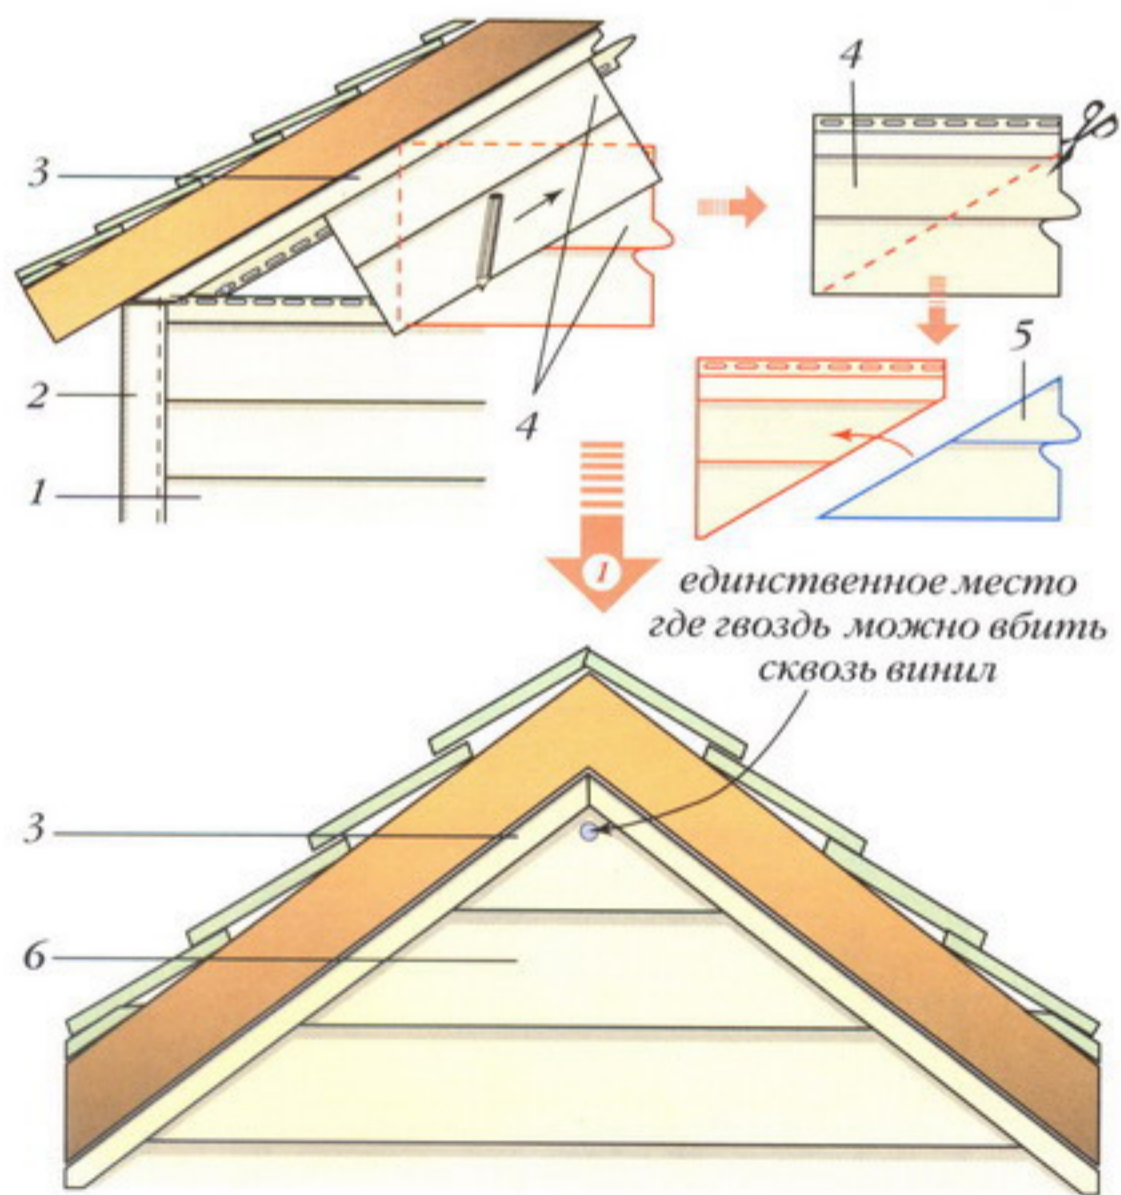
Изготовление шаблона и установка сайдинга на фронтоне: 1 – рядовой сайдинг; 2 – угловой профиль; 3 – J-профиль или виниловая доска; 4 – обрезок рядовой панели; 5 – шаблон; 6 – обшивка фронтона
